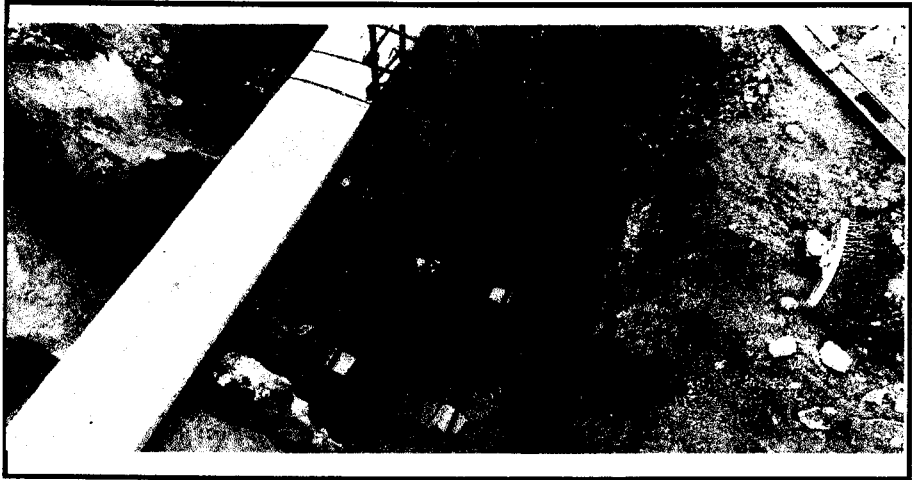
ACERO EN PARRILA DE ZAPATA TIPO 1 Y COLUMNA C1 TRAMO 4
